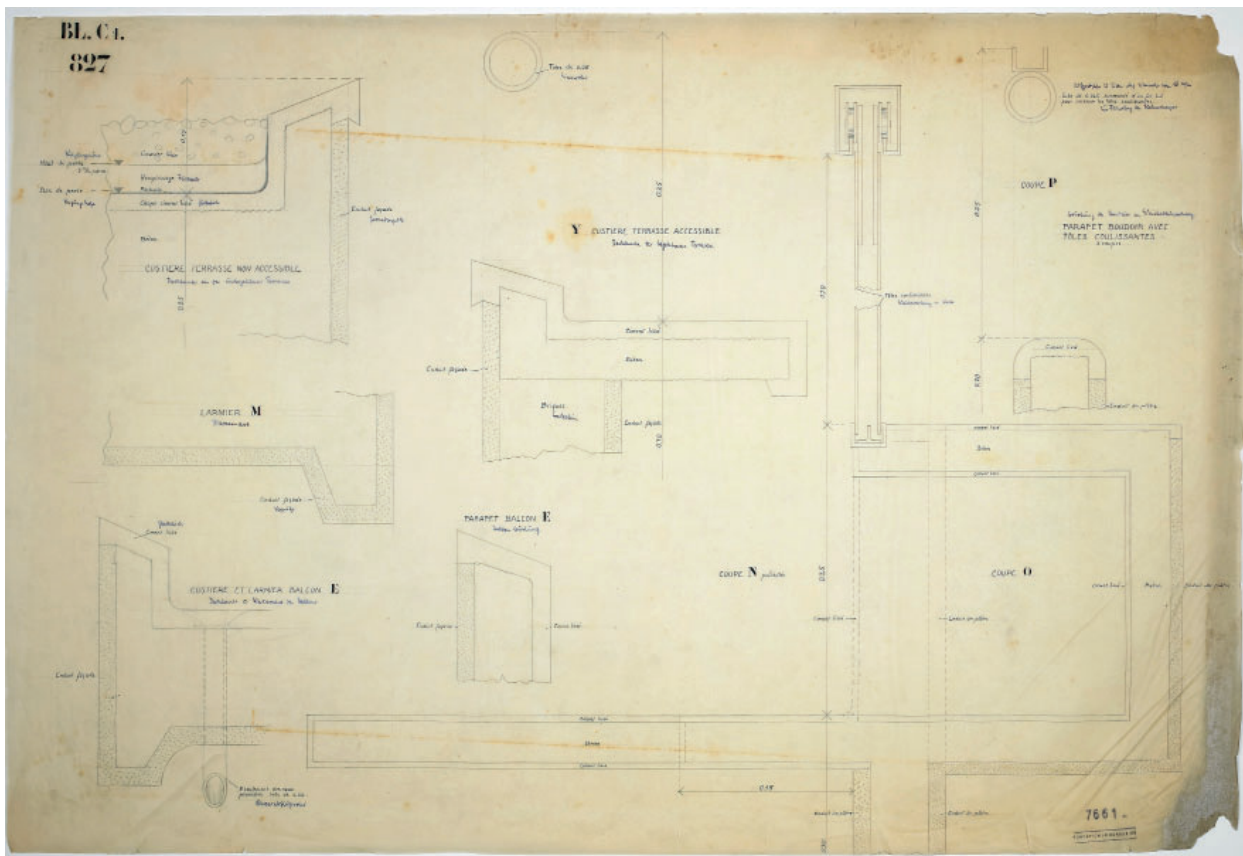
"BL. C1. 827". Detalles constructivos de las viviendas en Stuttgart, a escala 1:1, Atelier LC-PJ. FLC 07661.
